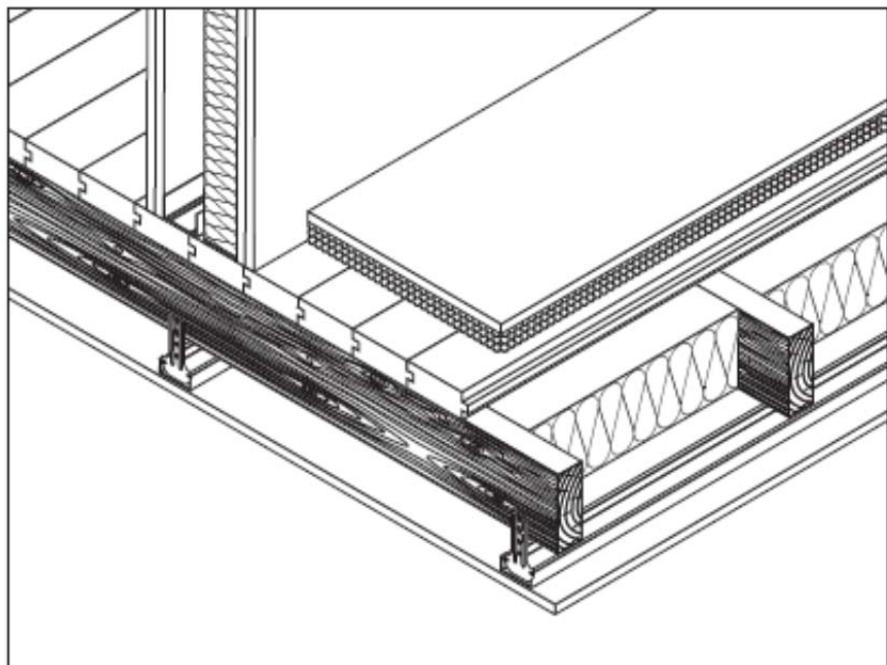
Raccordement sur plancher bois avec mise en œuvre d'une chape Placosol
